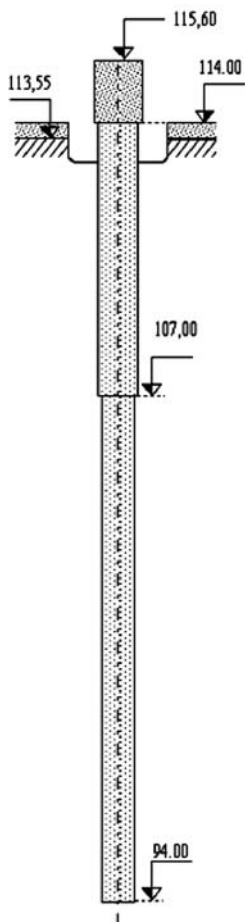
Конструкція залізобетонної палі для випробування на майданчику НБК для північної зони фундаменту [7]
